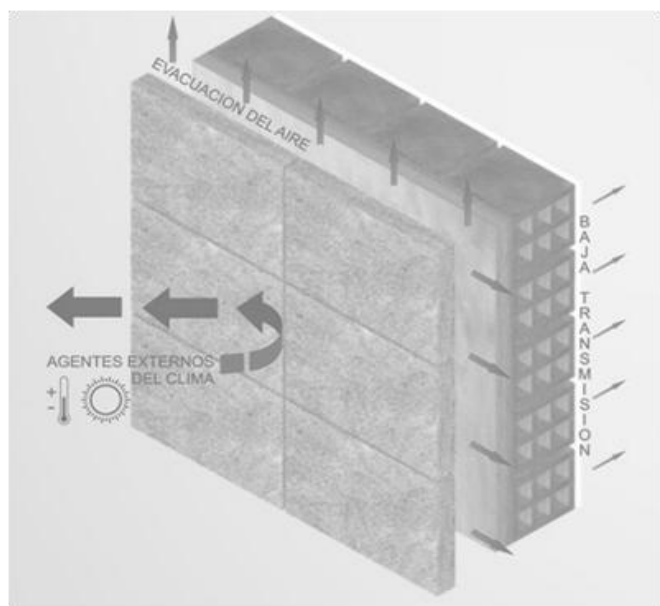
Funcionamiento de la fachada ventilada. Fuente: [www.masquepiedra.com](http://www.masquepiedra.com)
